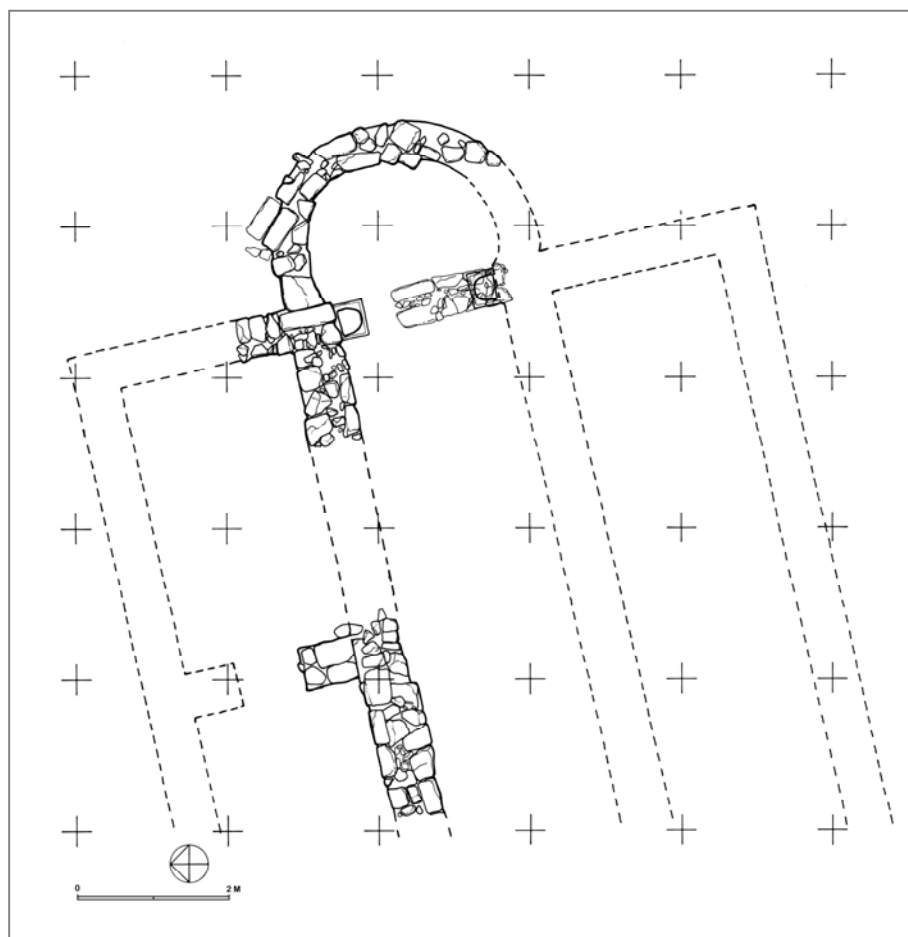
Castelo de Silves. Planta de estrutura religiosa cristã (seg. R. V. Gomes).
